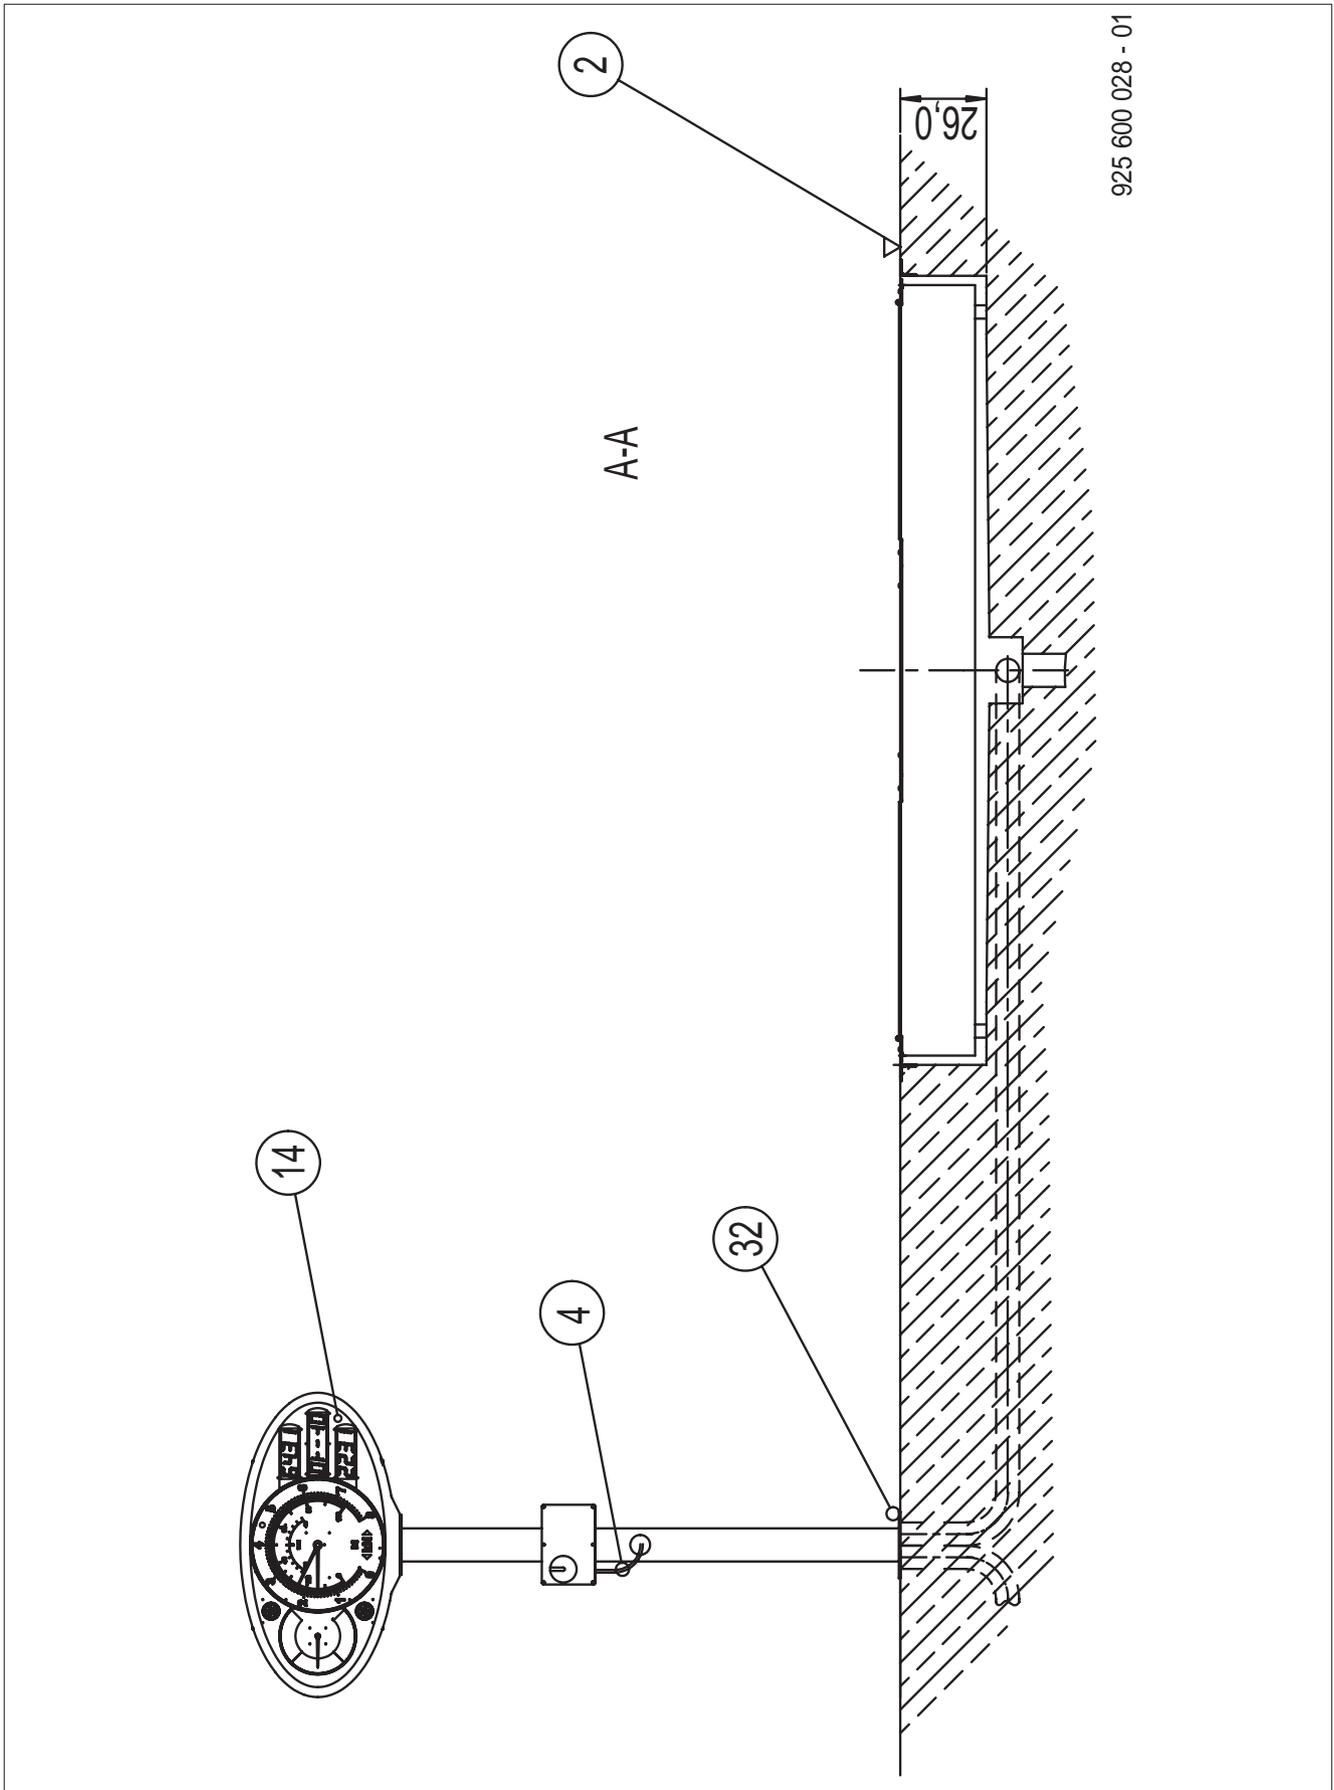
Installationsplan BD 6xx mit Standsäule - Schnitt A-A
